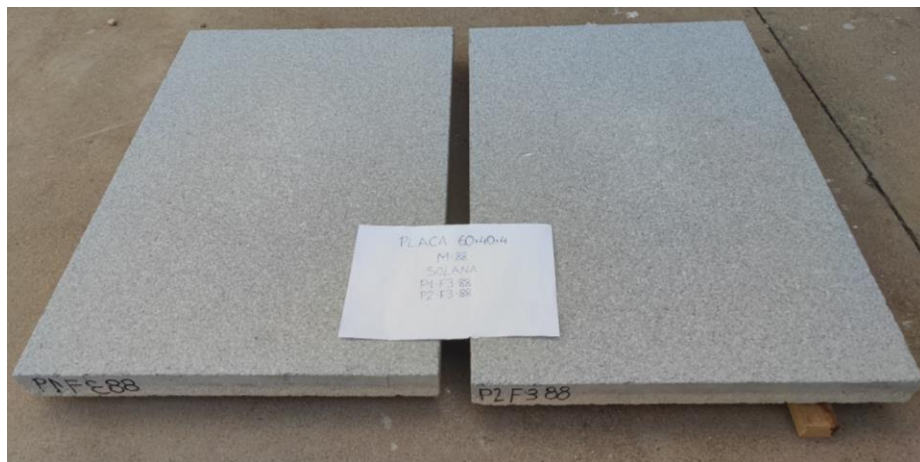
Fotografía pavimento M88 Solana. Fuente: Elaboración propia
